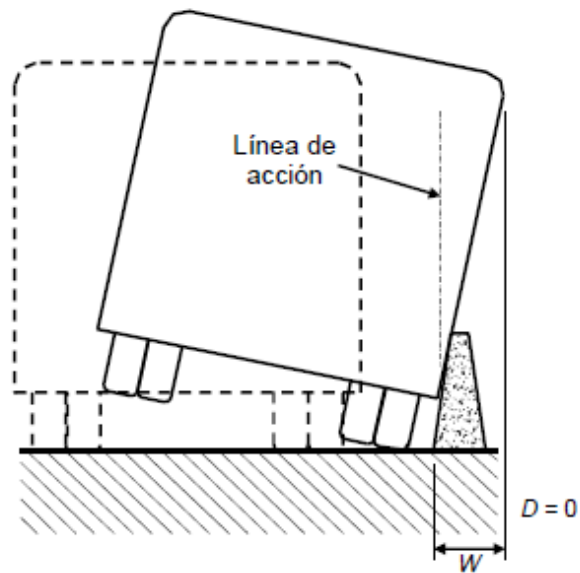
Deflexión y ancho de trabajo de una barrera rígida
